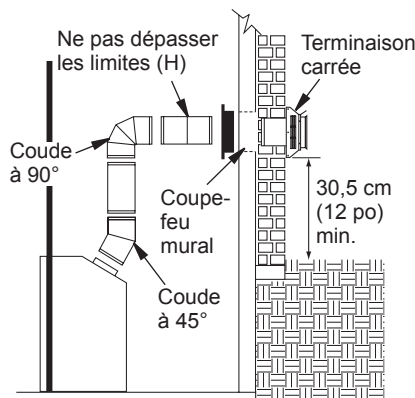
Configuration de terminaison horizontale pour installation en coin avec un coude à 90°
